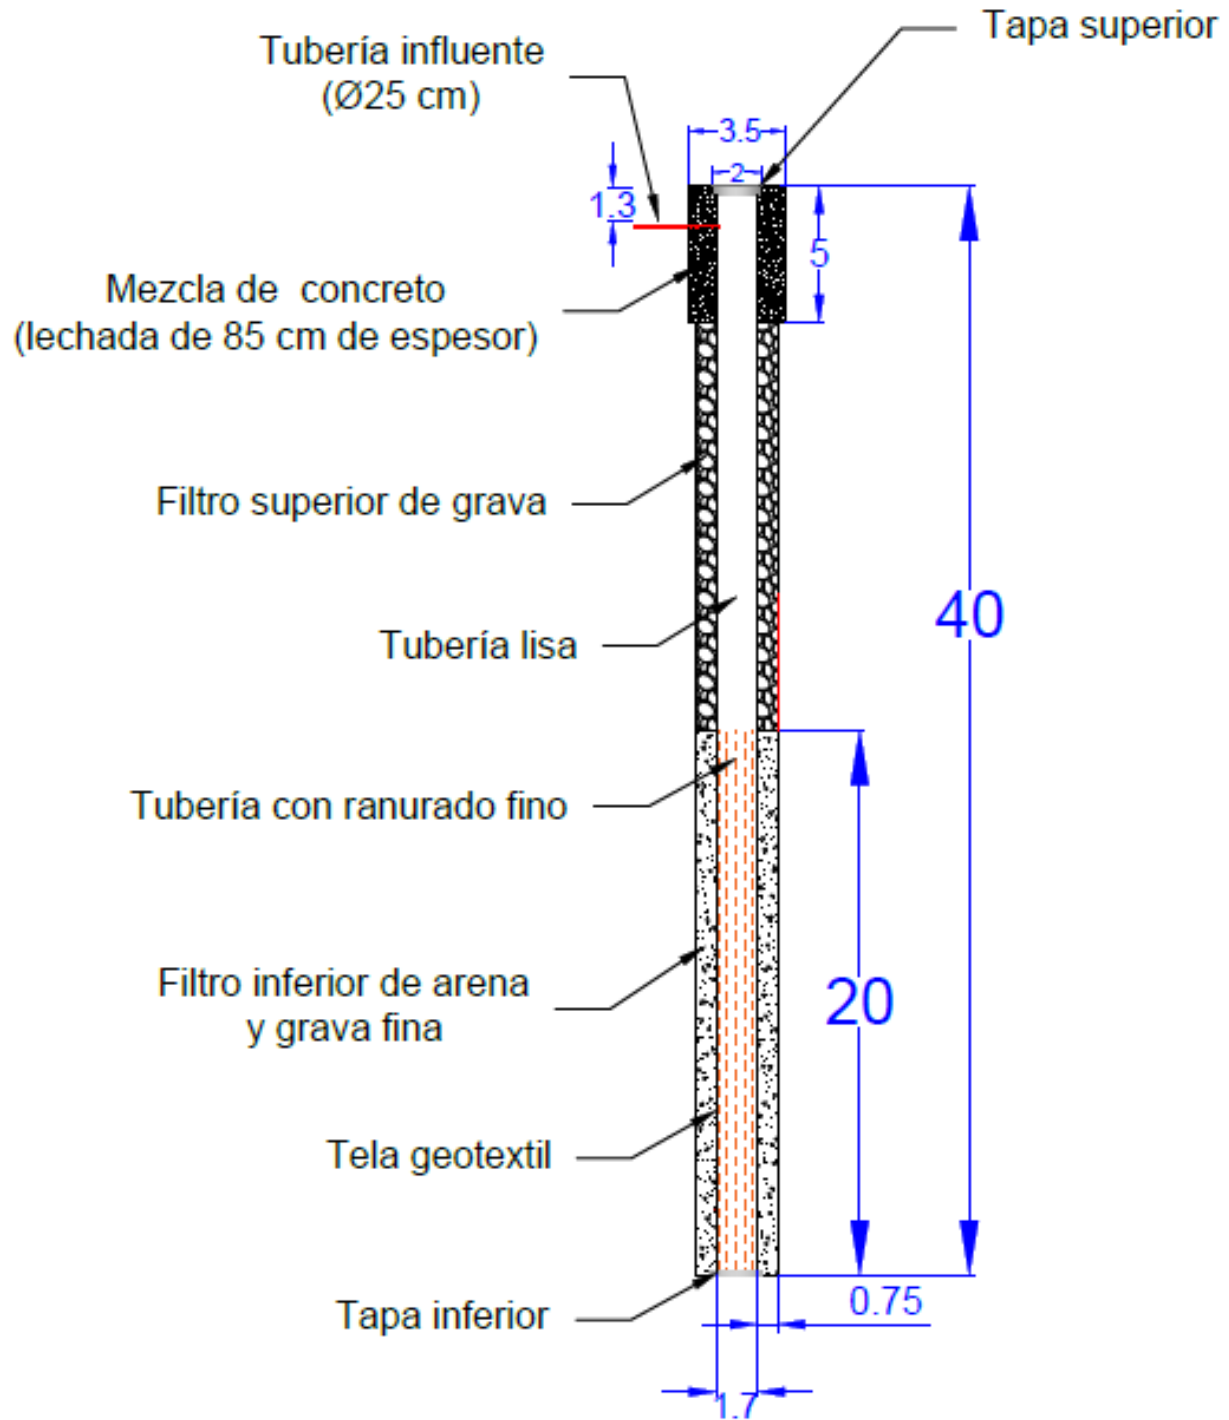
Pozo de infiltración, vista en perfil (cotas en metros)
